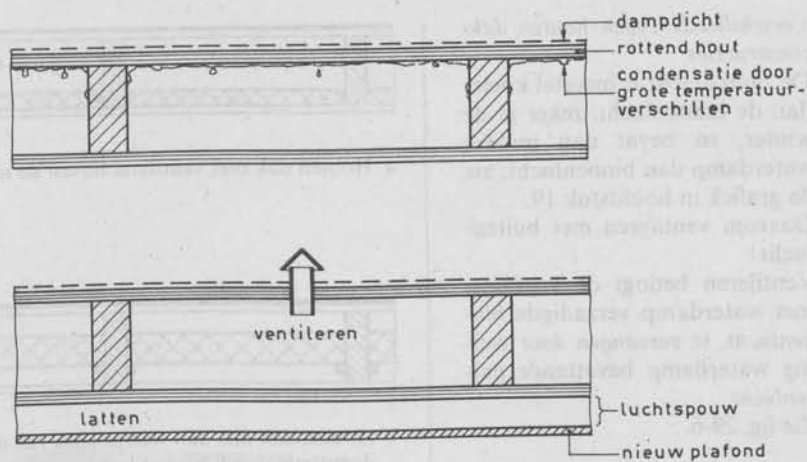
Verbetering van een bestaand plat dak door extra plafond.
